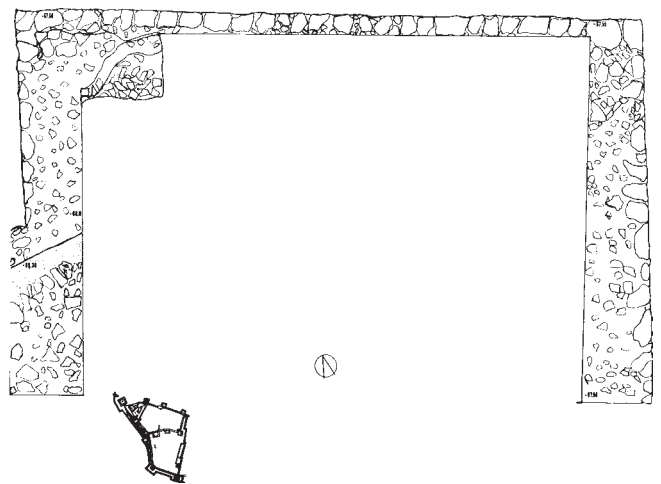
Torre 8. Planta de excavación de su cimiento.
